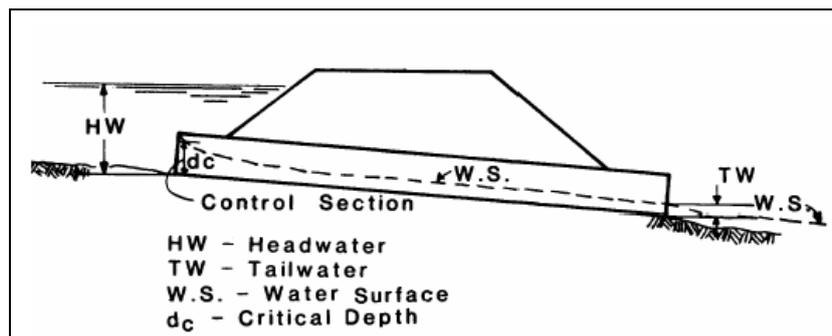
Esempio di moto controllato dalla sezione di ingresso.
